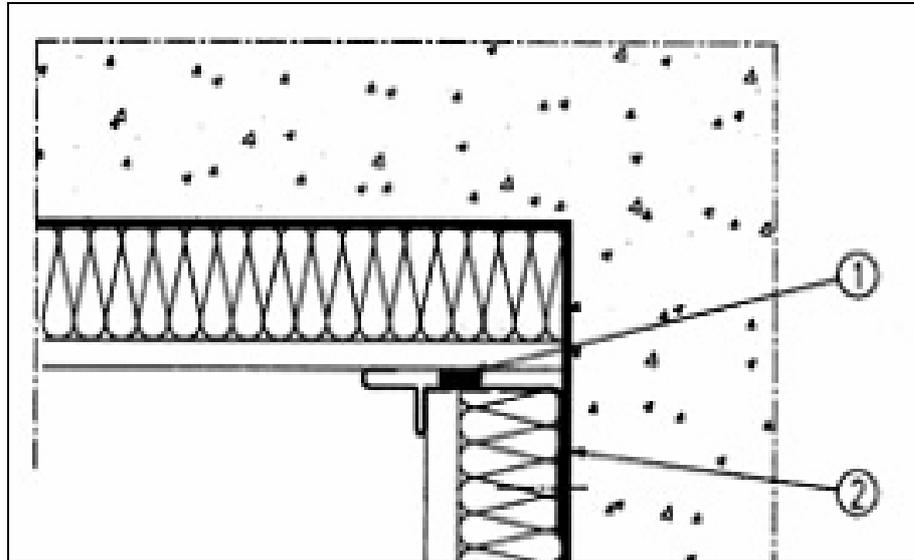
Solución a punto singular en ángulo que vuelve en vertical para el sistema de unidad prefabricada.
